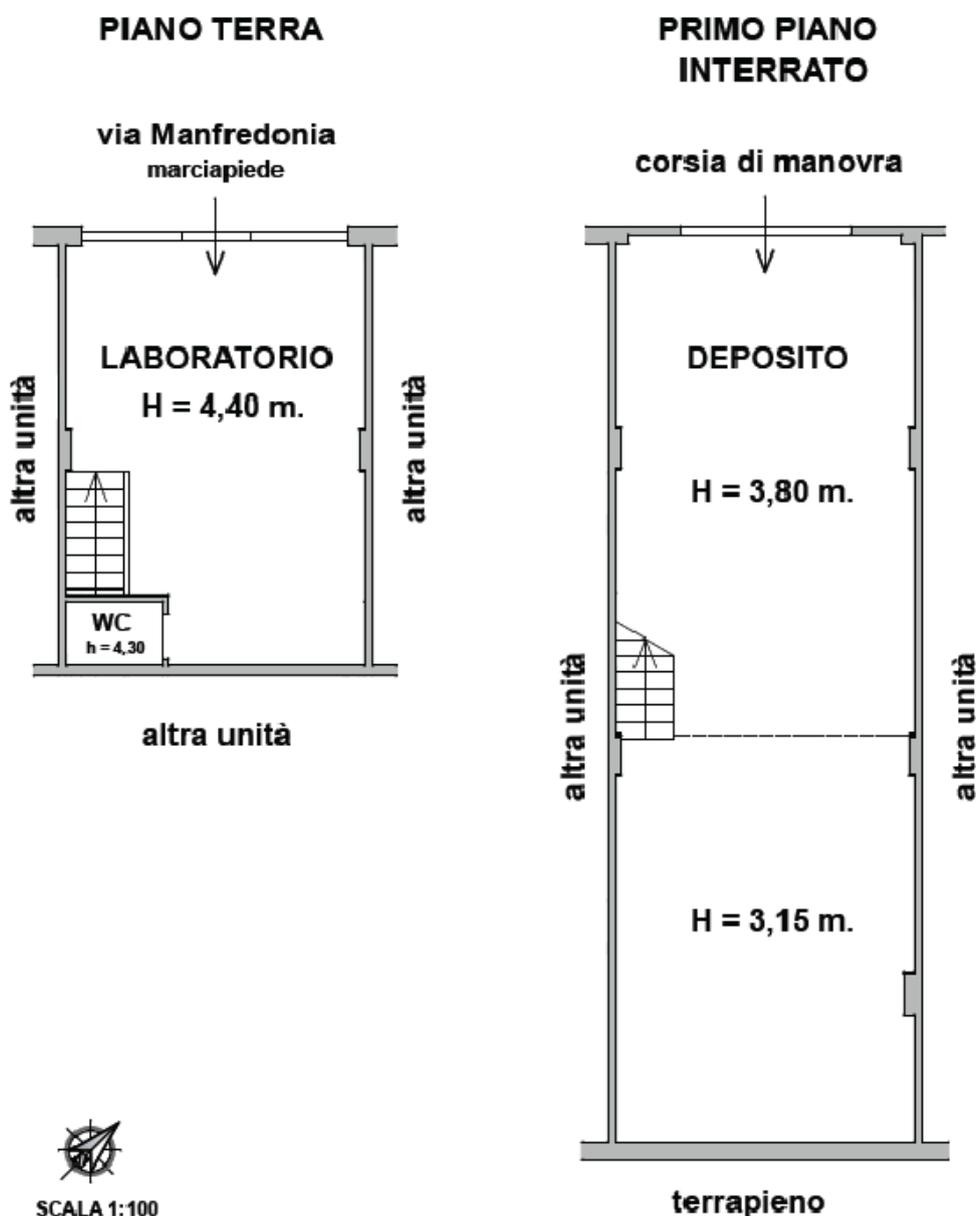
LOTTO 2 - Planimetria laboratorio artigianale foglio 52 - part. 604 - sub. 14
